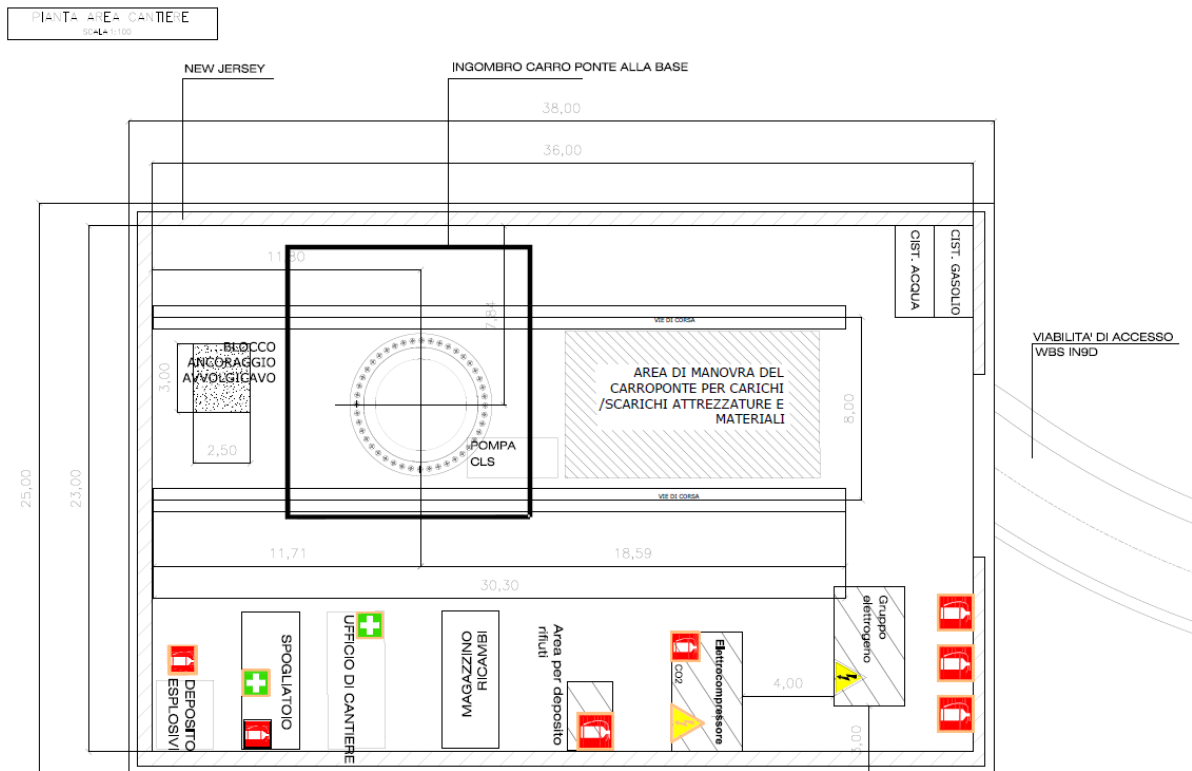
Cantiere pozzo: fase 2 – alesatura pozzo con scavo dall'alto
